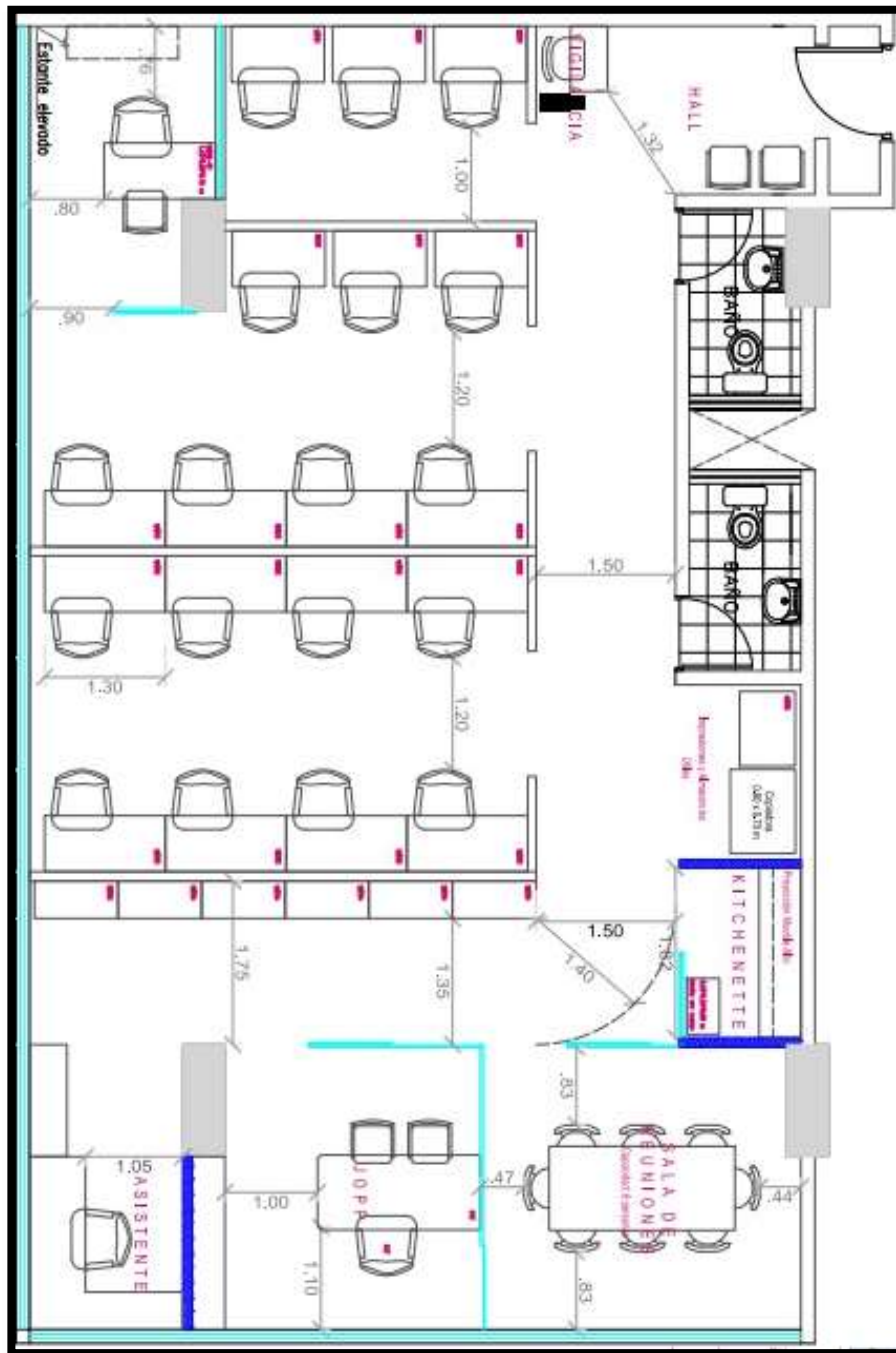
Plano de distribución de oficinas y área 7004.
